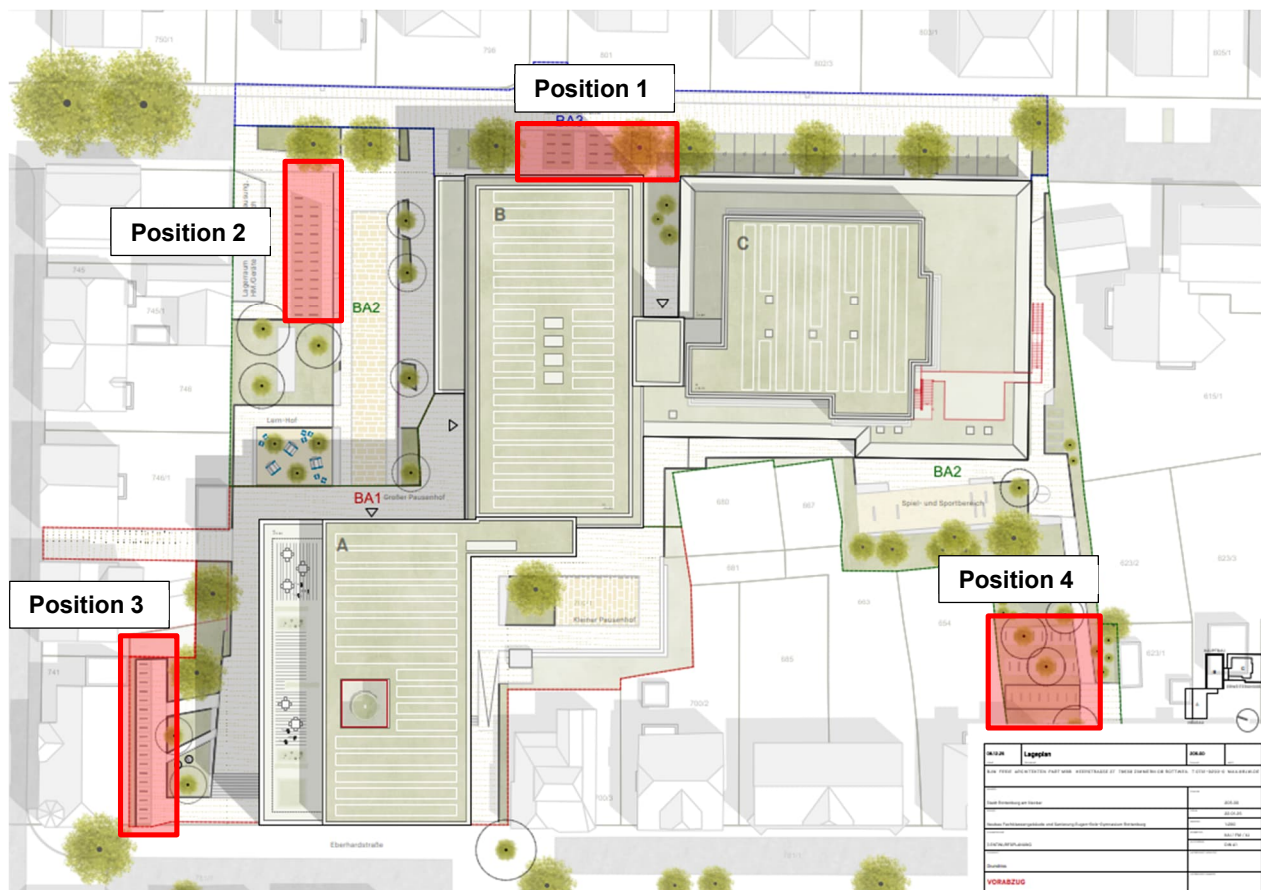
Lageplan mit Kennzeichnung der Fahrradstellplätze
